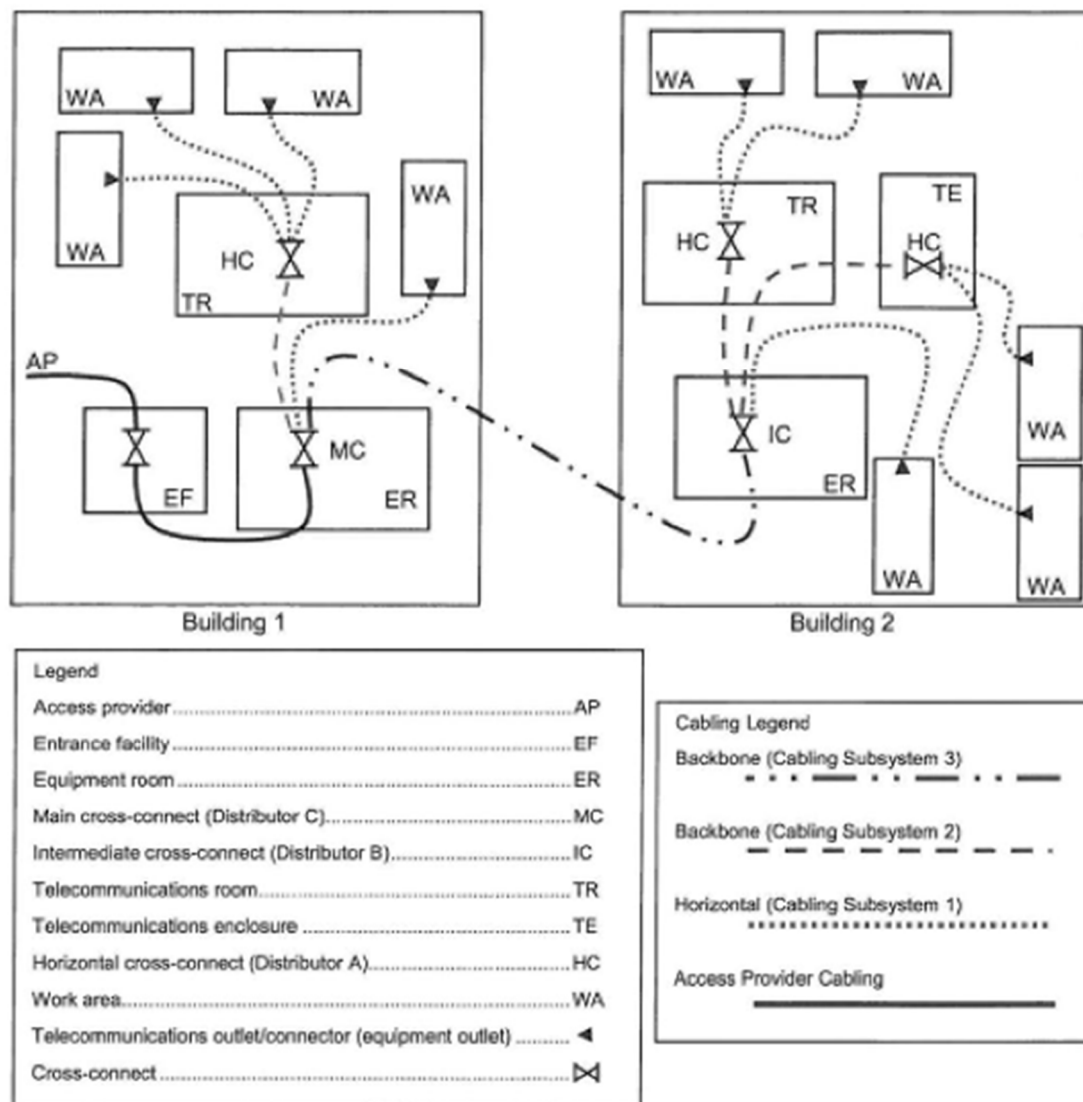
11: Esquema de los elementos del cableado estructurado.
